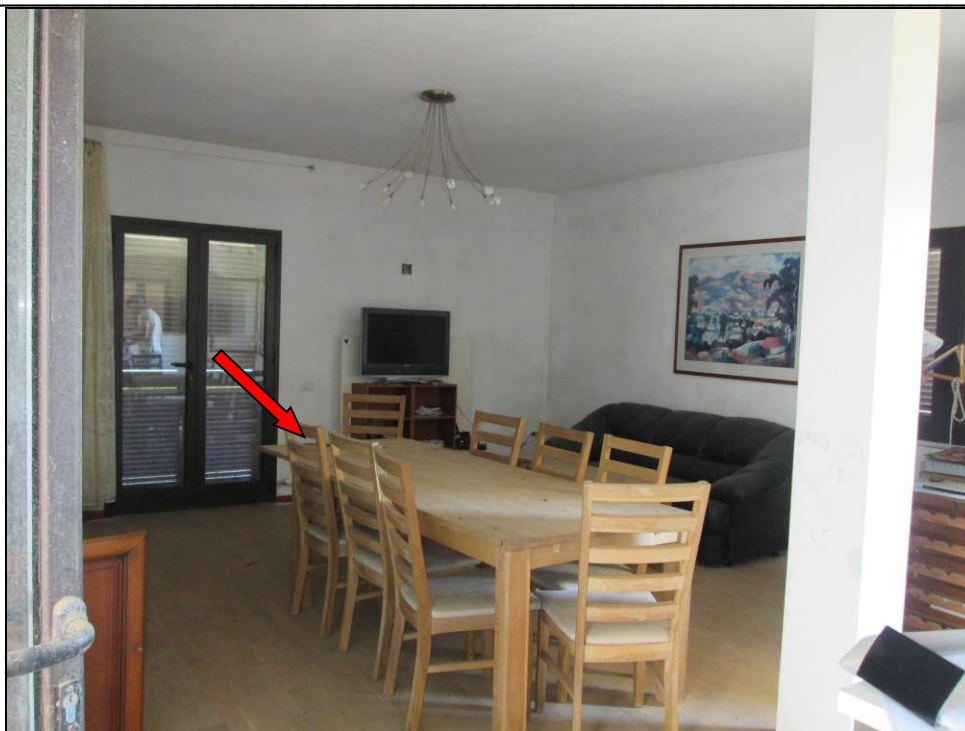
locale deposito trasformato in soggiorno con abbattimento muro –
